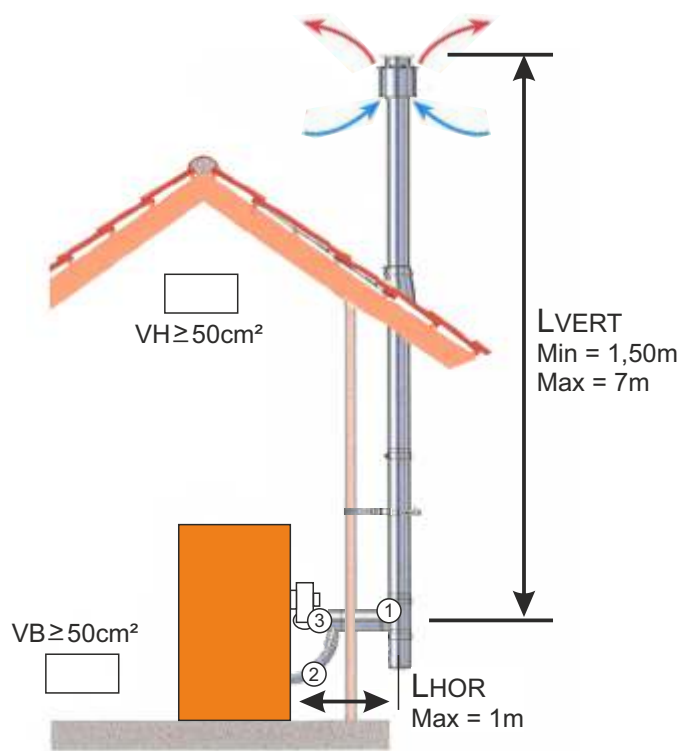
Terminal-verticale, avec le conduit d'évacuation à l'extérieur de la chaufferie
